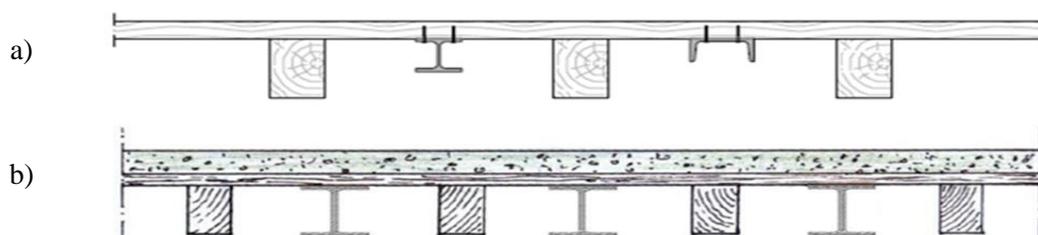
Exemplo de reforço de pavimento através da colocação de vigas metálicas paralelas ao vigamento existente: a) (Brites, 2011); b) (Carneiro, 2012)
